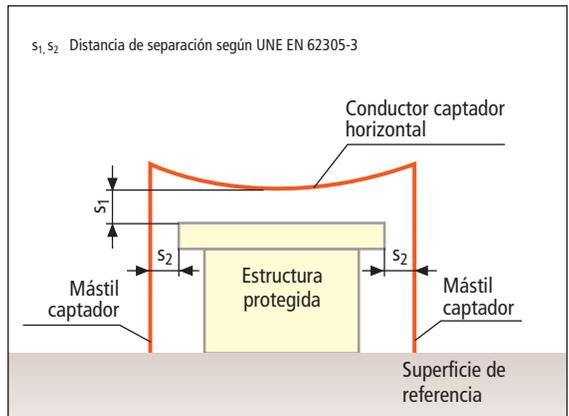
Sistema de protección externa contra rayos aislado, compuesto por dos mástiles captadores separados, unidos entre sí con un conductor horizontal captador: Proyección sobre una superficie vertical mediante dos mástiles (alzado).
